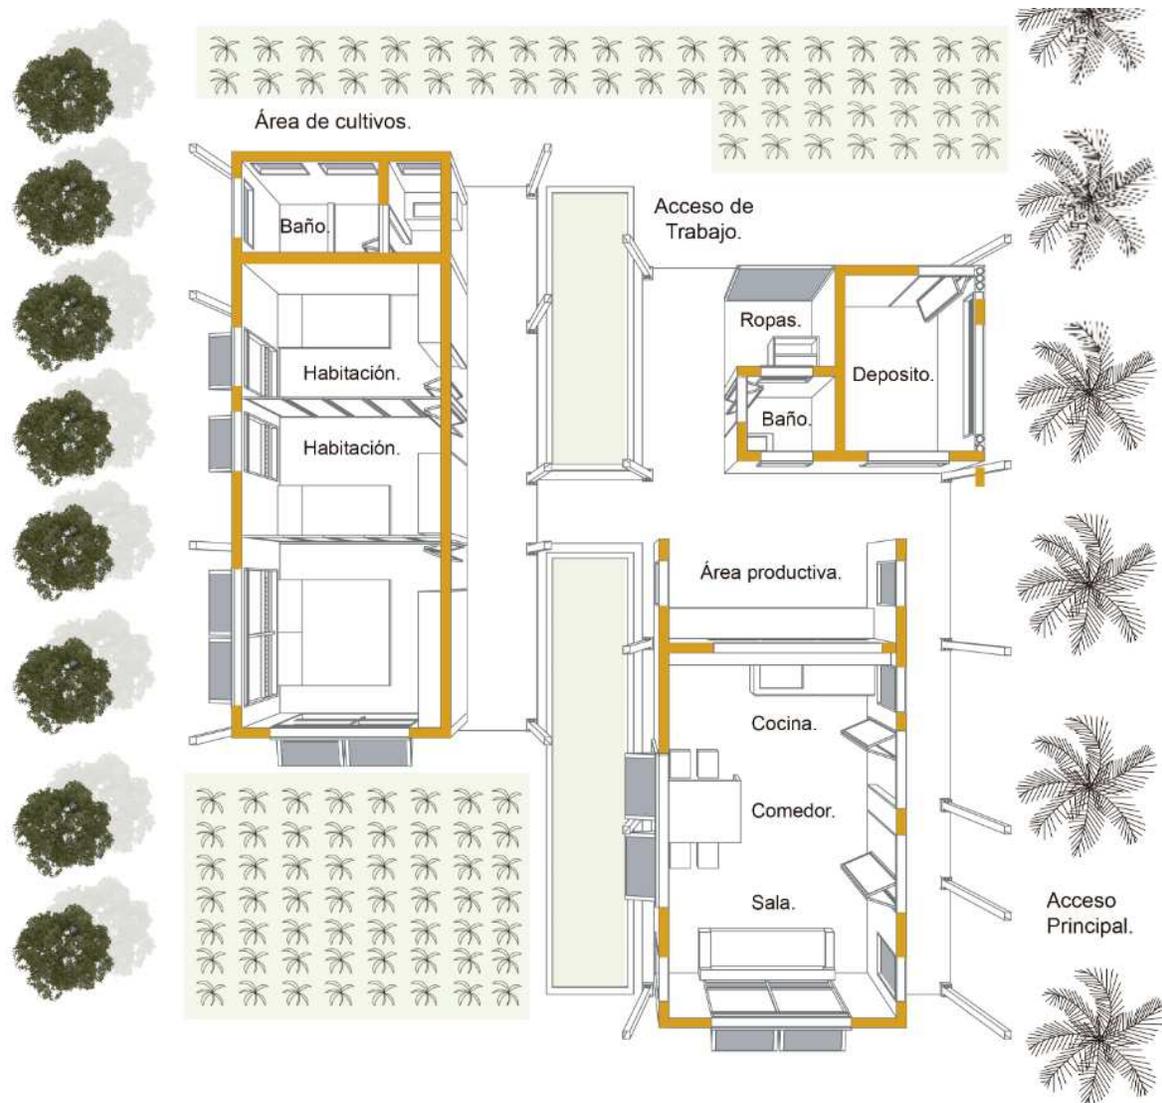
Planta arquitectónica la vivienda, fuente propia.
